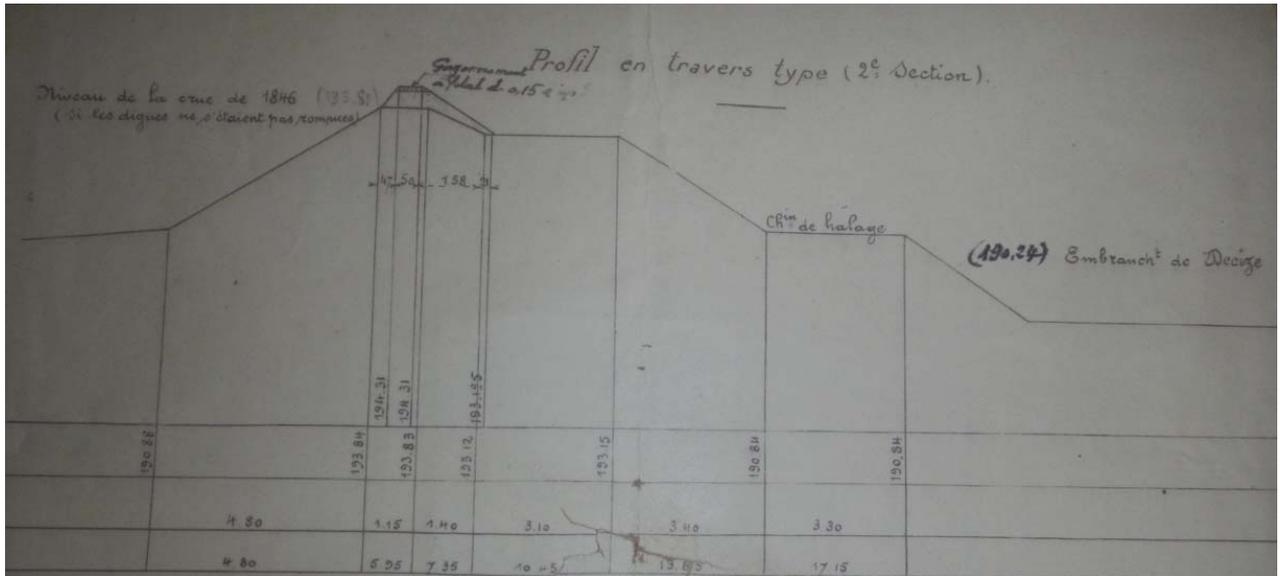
Profil type de la levée de la Jonction 2e section après exhaussement - Source : Archives DDT 58
